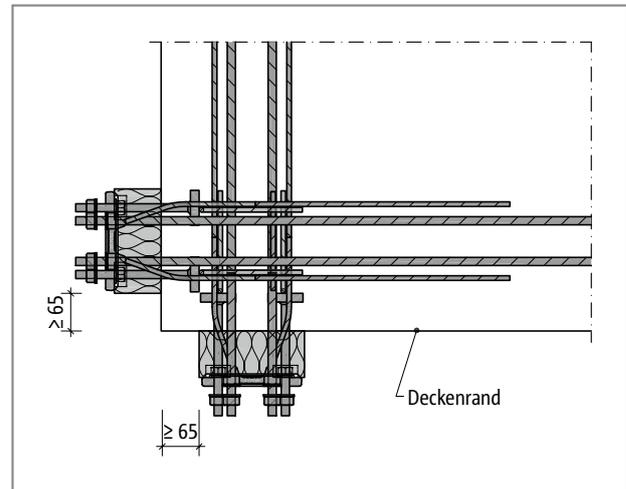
Schöck Isokorb® T Typ SK mit Stahlschwert: Randabstände an der Außenecke bei zwei senkrecht zueinander angeordneten Isokorb®
